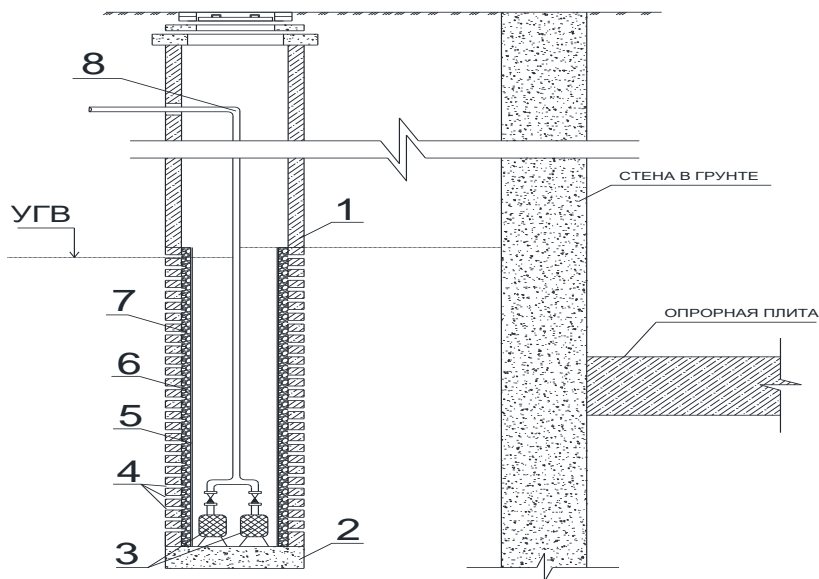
Конструкция вертикального дренажа в виде железобетонного колодца
